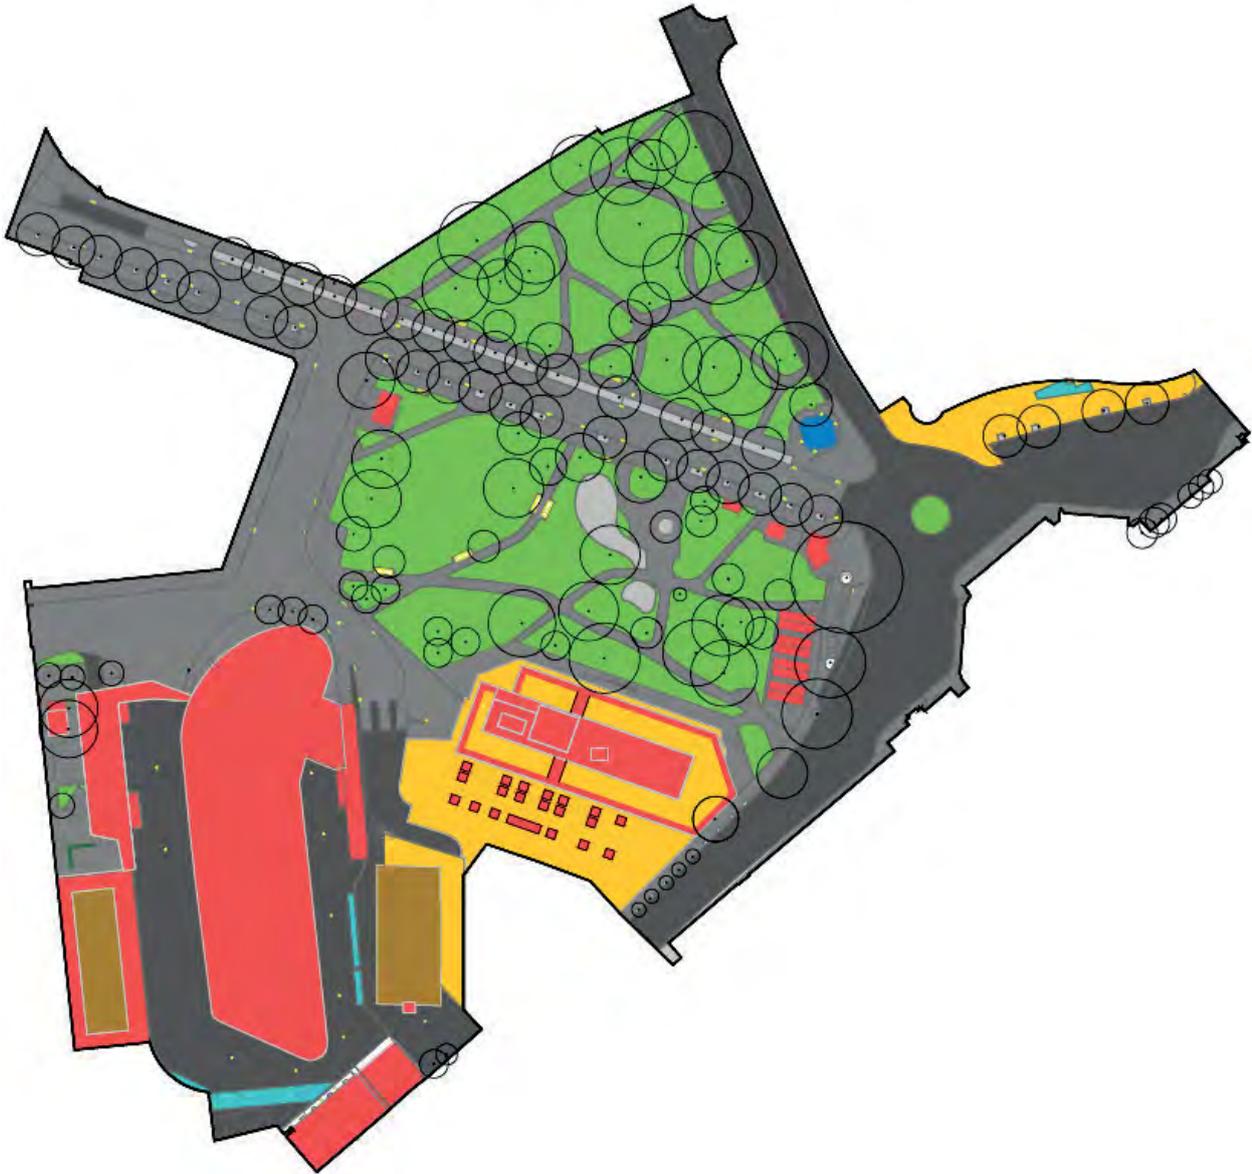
RIE- Verringerung der Auswirkungen aus den Baumaßnahmen – R.I.E. 1 – Oberflächen - Grünflächen - versiegelte und durchlässige Oberflächen - Grundriss
